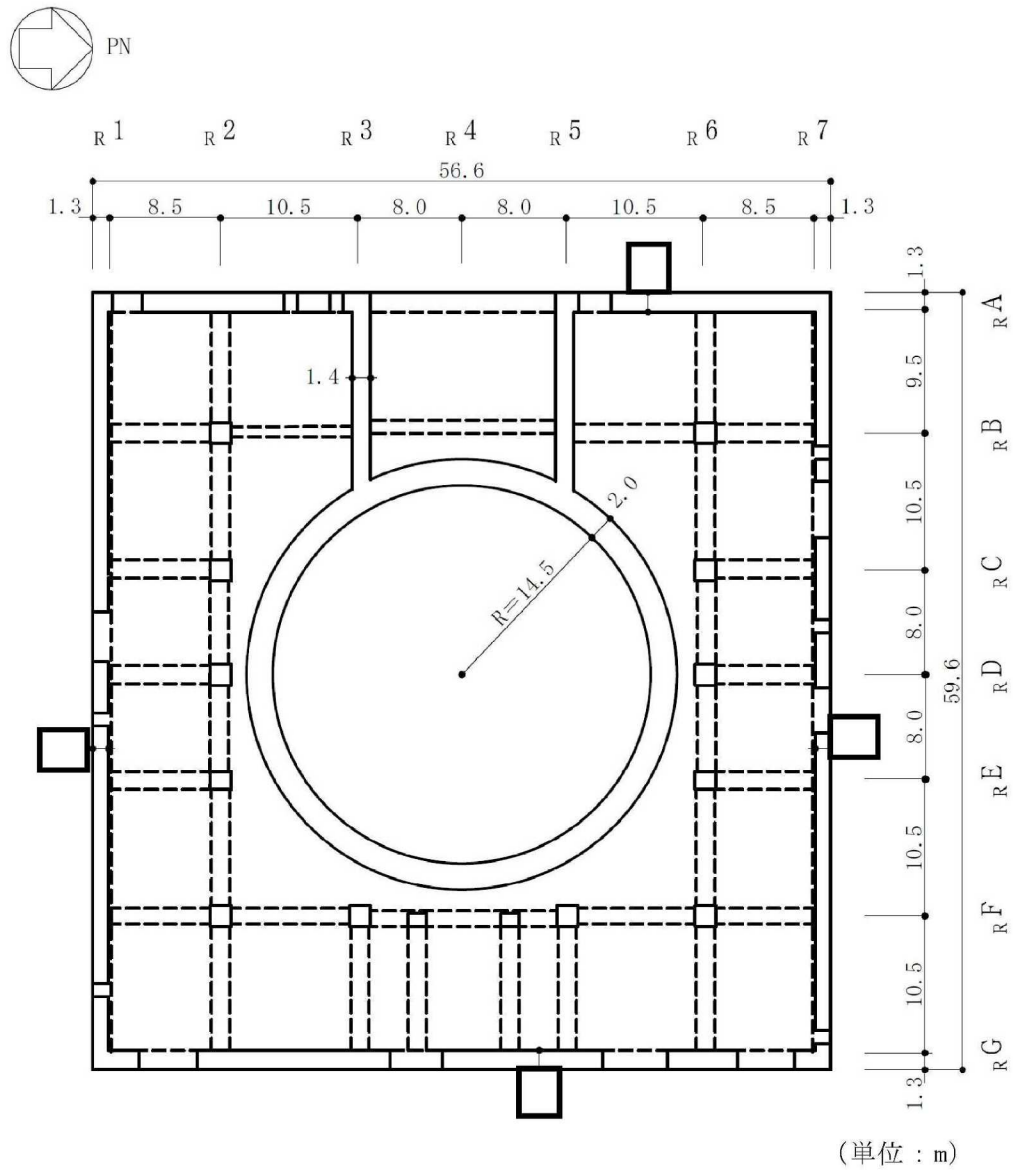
原子炉建屋の概略平面図 (1F, T.M.S.L. 12.3m) (4/9)
